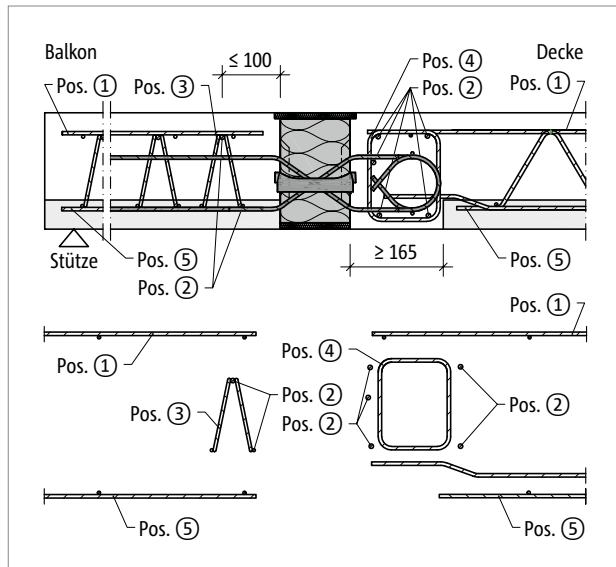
Schöck Isokorb® XT Typ QL-VV1 bis VV4 Bauseitige Bewehrung mit Gitterträger
